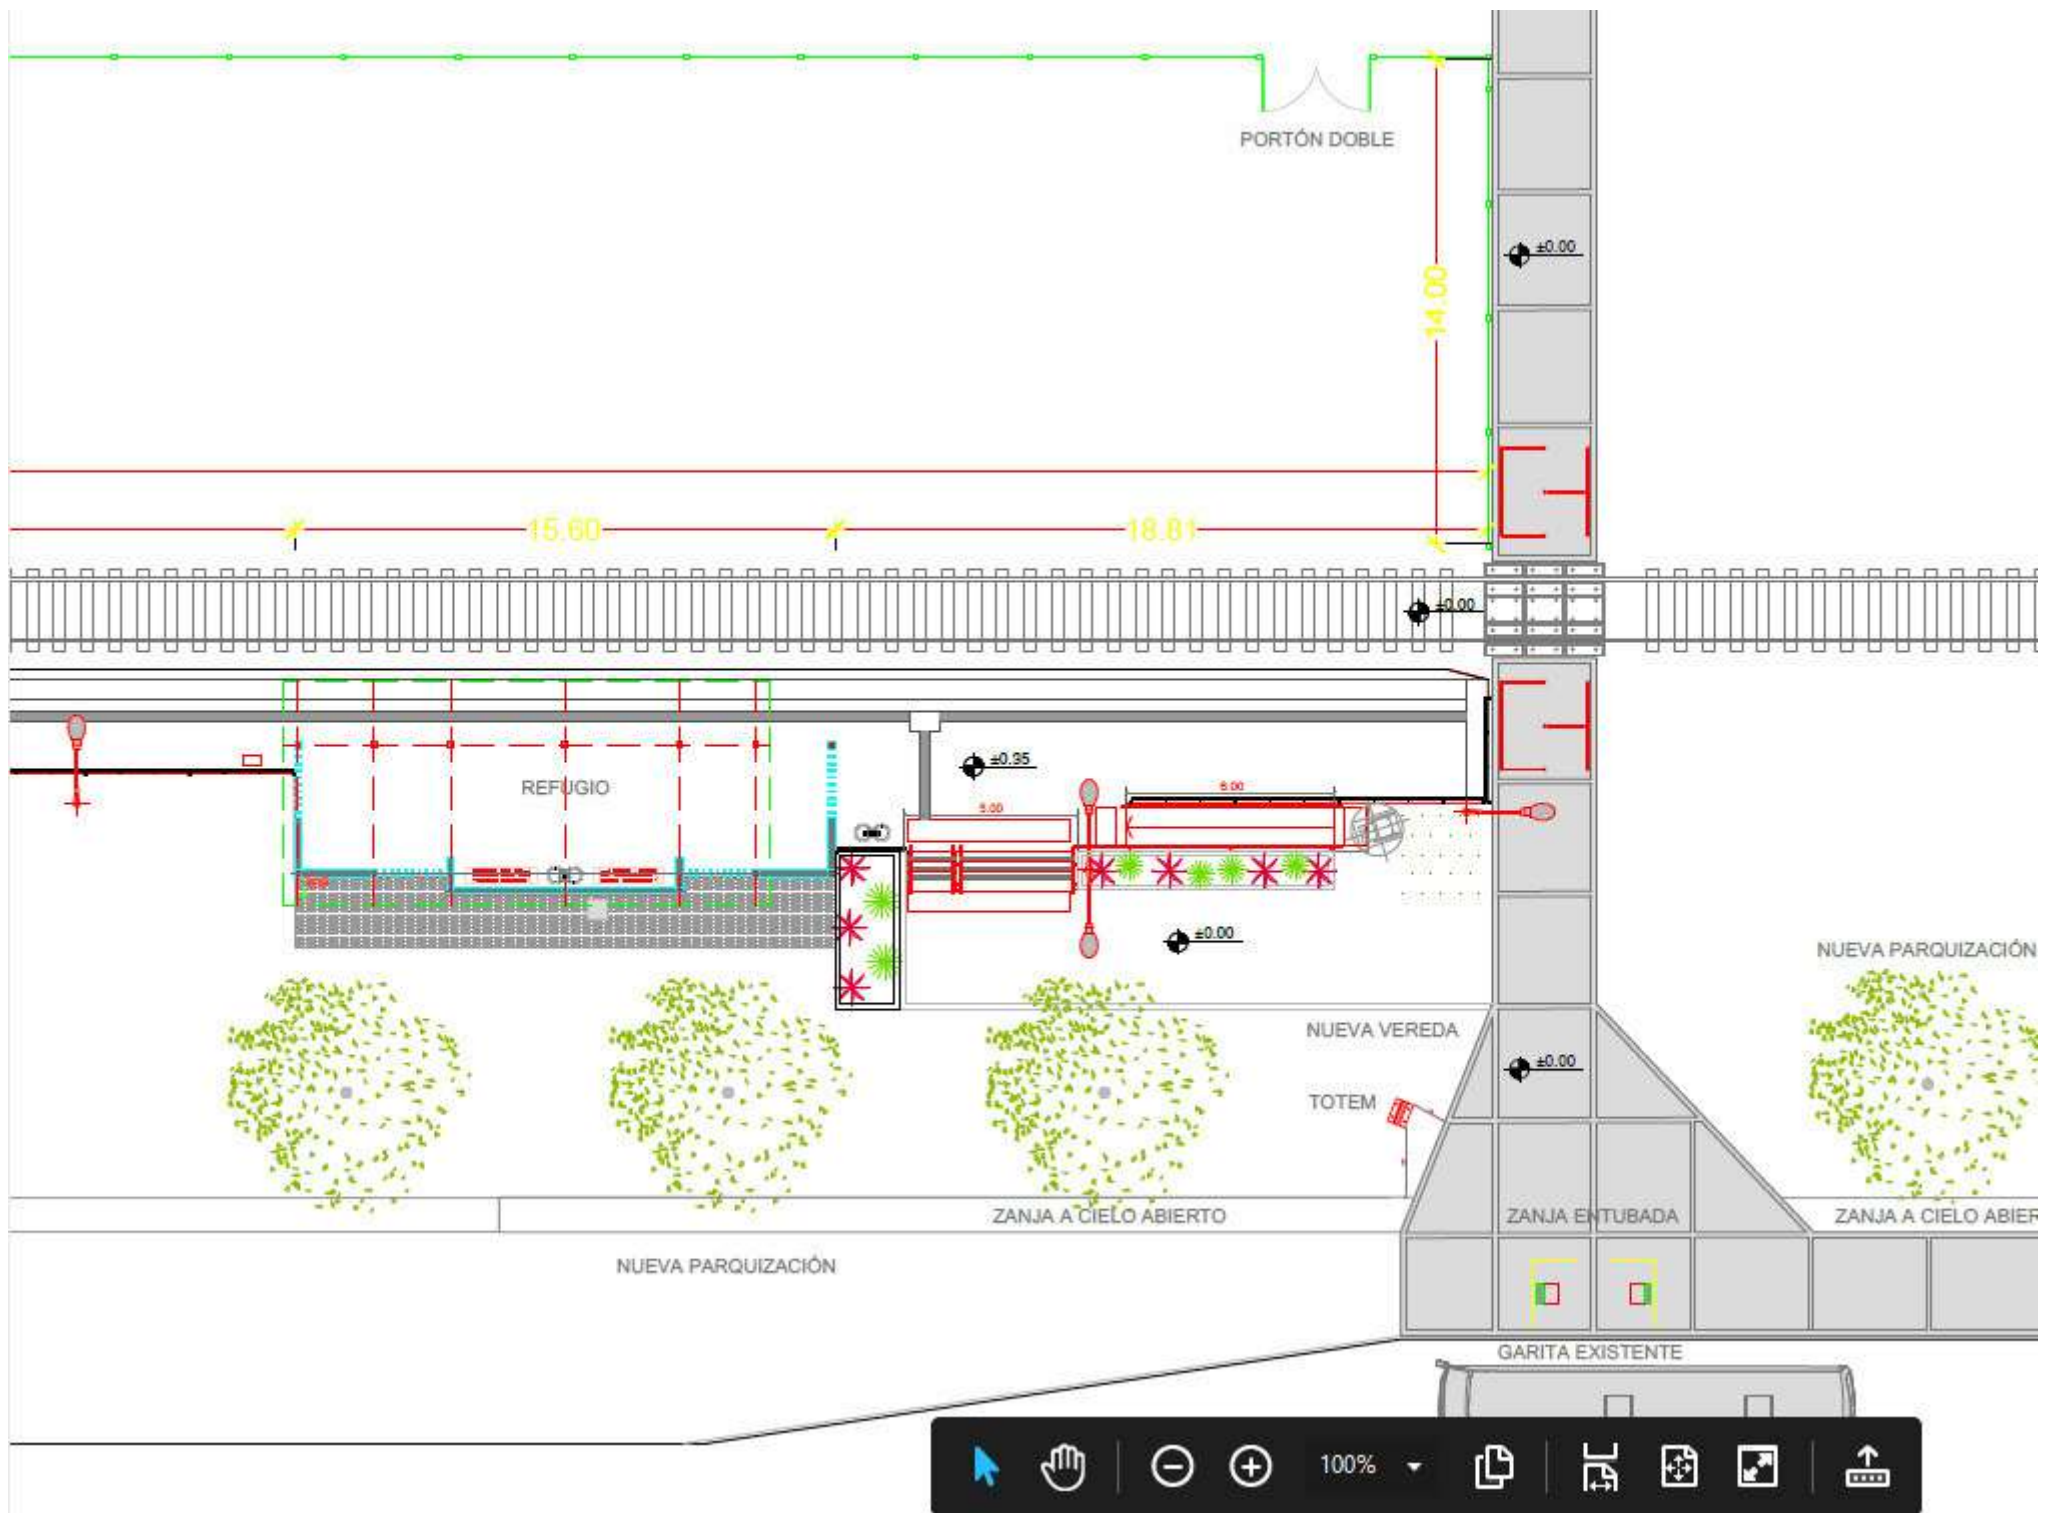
Recorte Planta Nuevo Apeadero Marcos Paz
